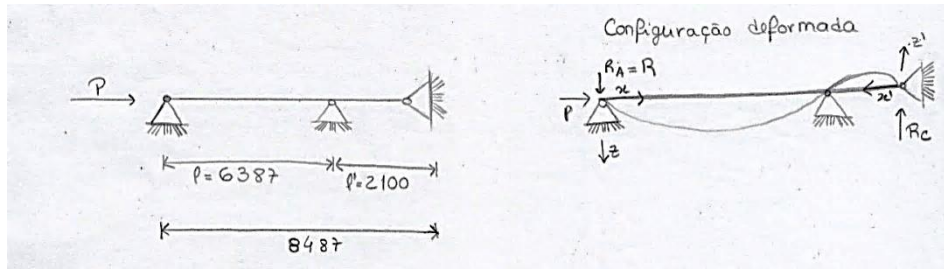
Modelo estrutural para determinação do comprimento de encurvadura da viga no plano de estrutura (plano x – z)
